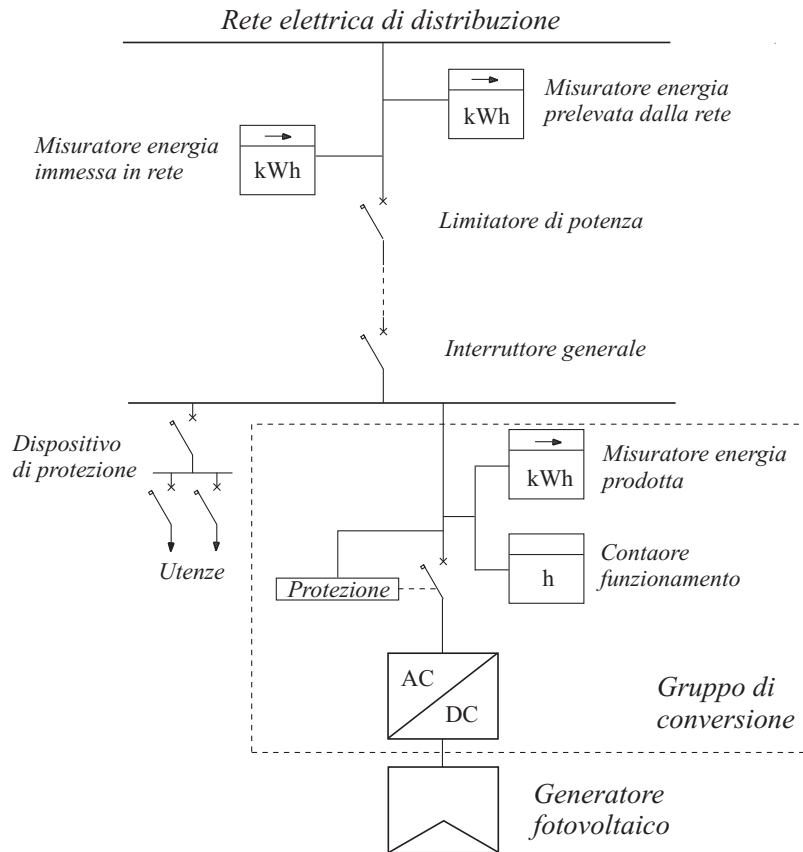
Schema unifilare di collegamento di un impianto fotovoltaico alla rete elettrica di distribuzione.
